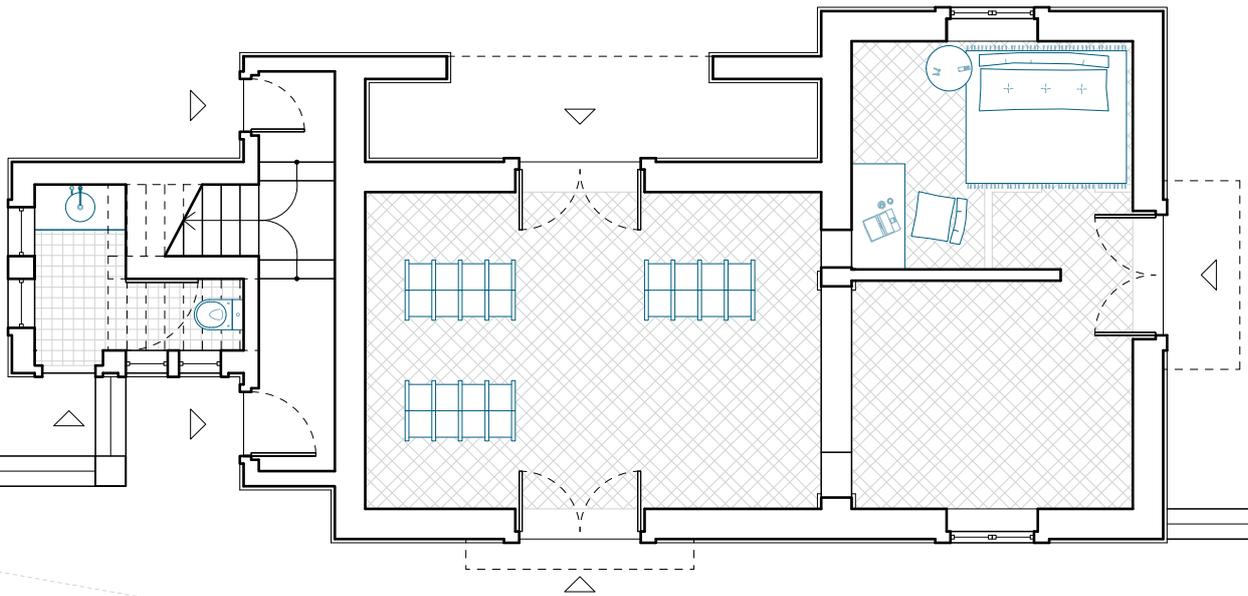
Plantas do Edifício de Passageiros - Piso Térreo
